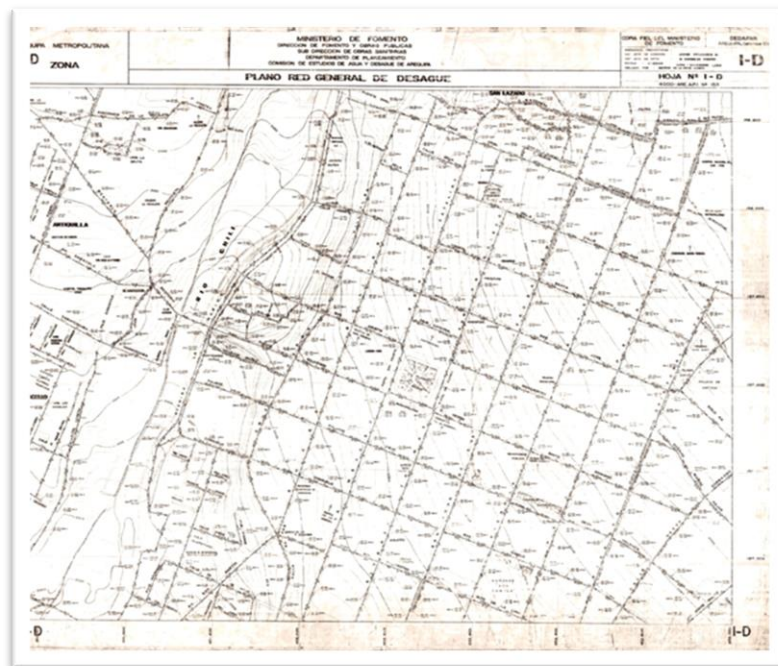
Vista de láminas de planos de Ozalid. – Sistema de Alcantarillado de AQP
